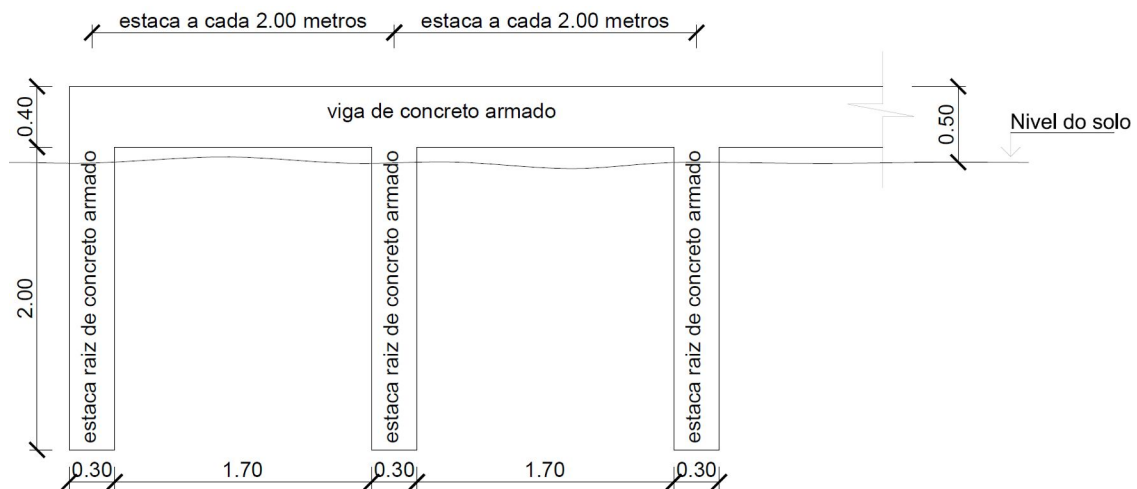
Detalhamento do bloco de assentamento das escolas em corte.
